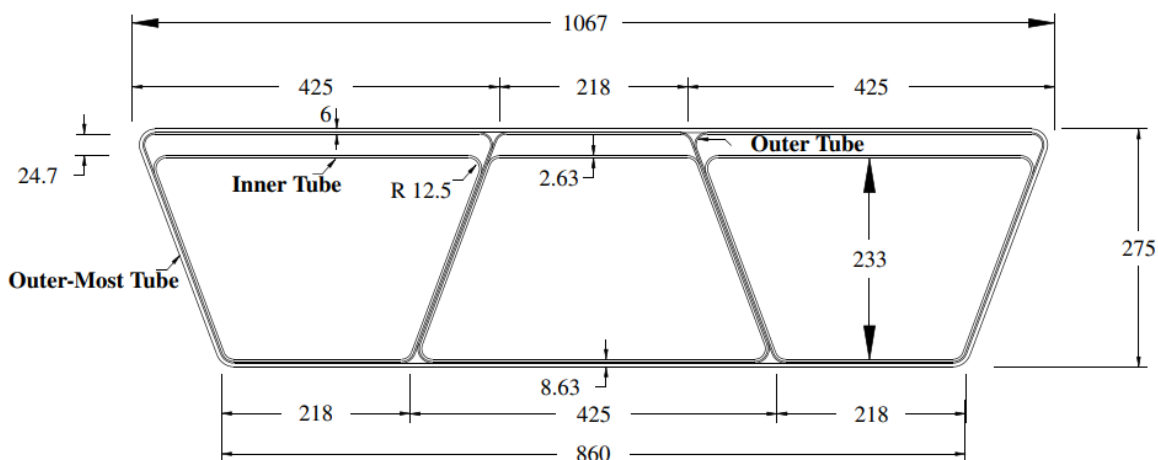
Поперечное сечение гибридного пролетного строения из стеклопластика и бетона [1]
